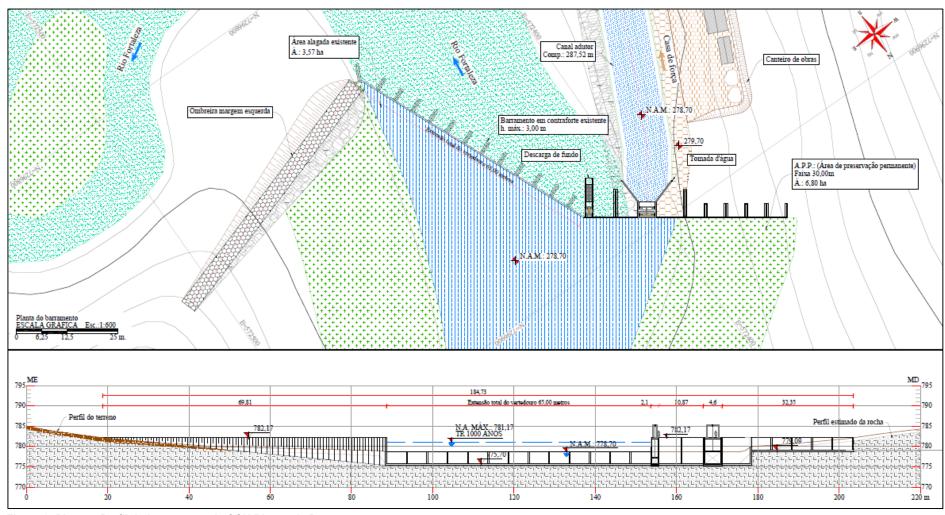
Planta e Perfil do barramento da CGH Rincão da Ponte.
